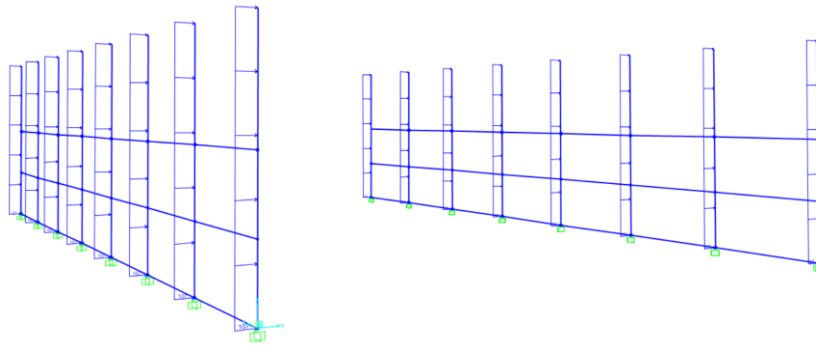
Aplicación de la carga de viento en las columnas nave industrial 1
